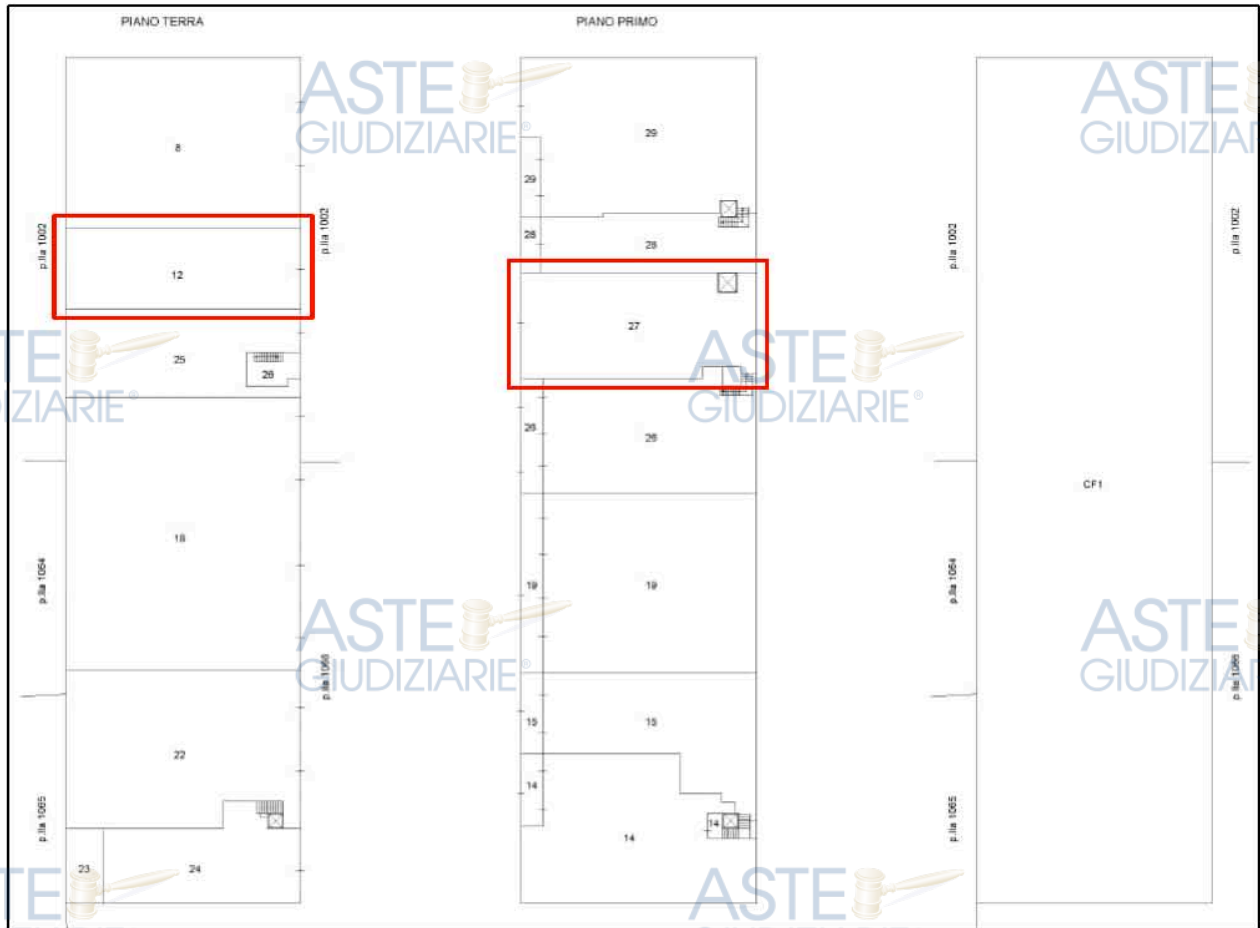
Stralcio elaborato planimetrico particella 366 del foglio 73 del comune di Catanzaro - Individuazione subalterni oggetto di esecuzione
